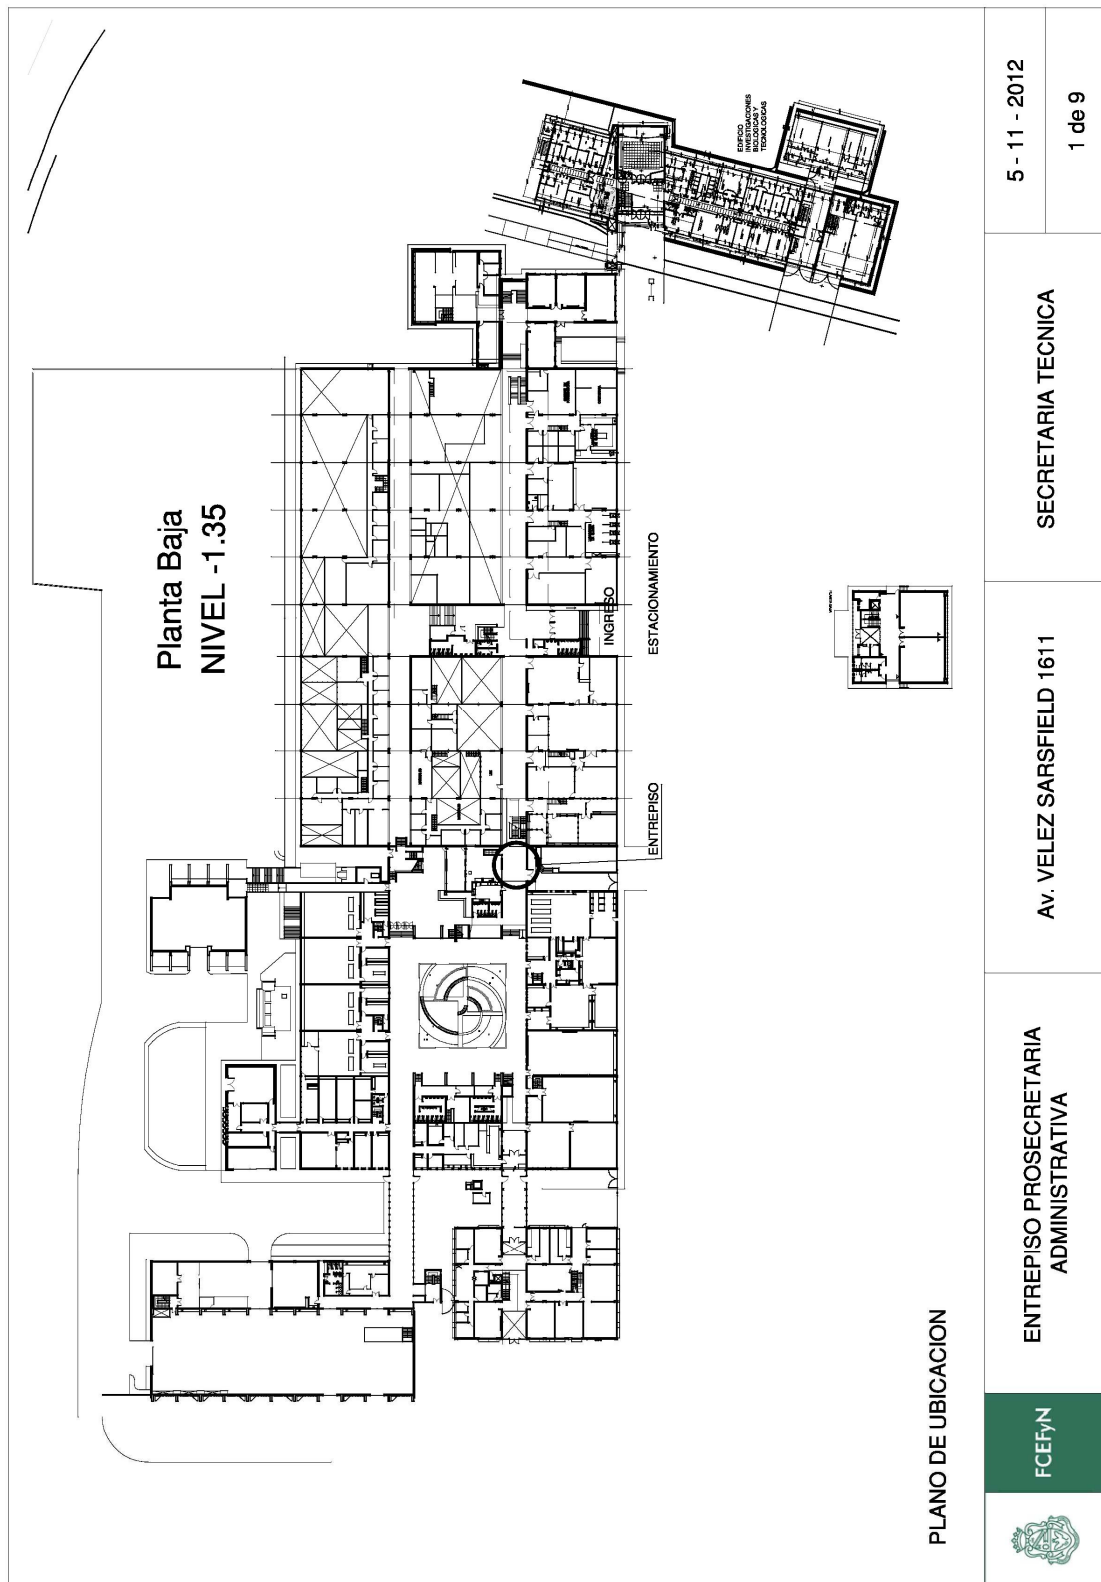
Plano 1– Fuente: Digitalización de planos originales
